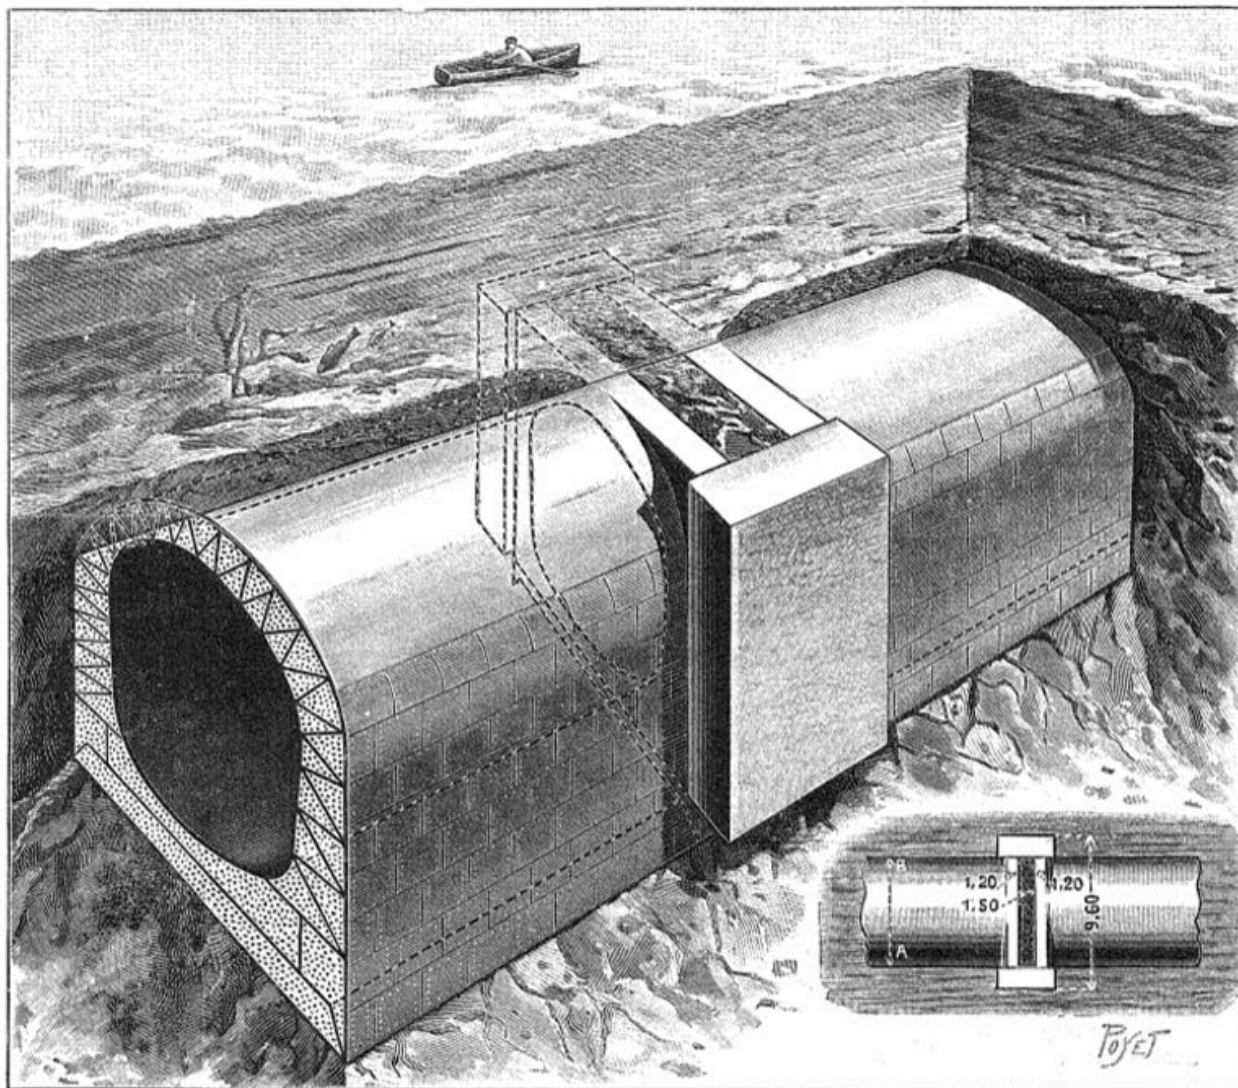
La première phase du « joint » : construction des murs latéraux extérieurs qui supporteront le caisson batardeau.
